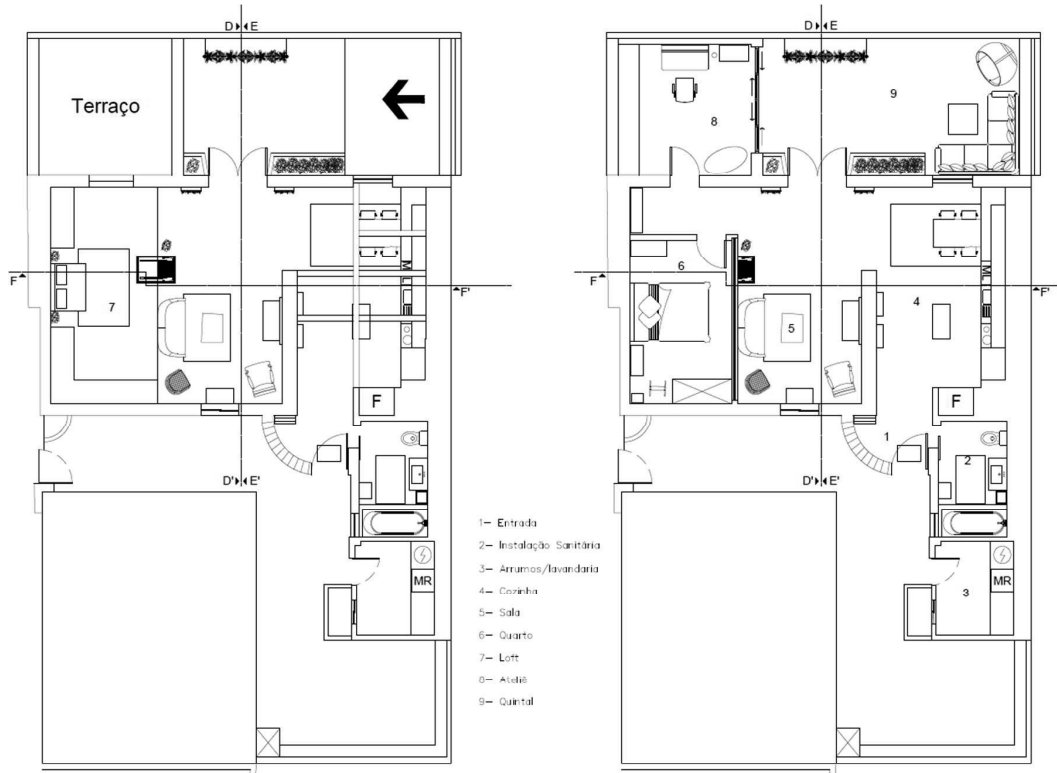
Planta de apresentação. Fonte: Andreia Paim
